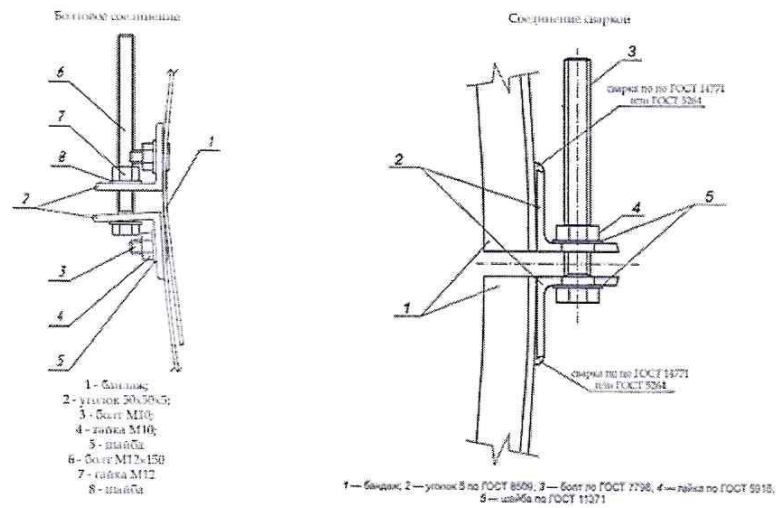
Конструкция болтового и сварного крепления уголка 50x50x5 к бандажу СВМГТ
